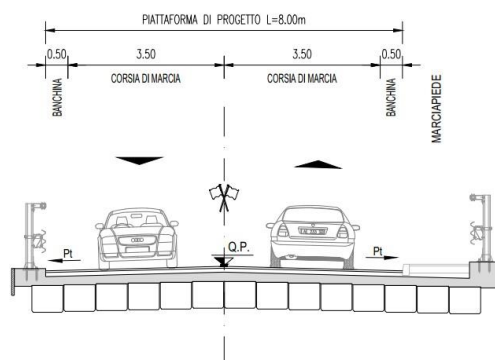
Sezione tipo viabilità interna - ponte Cretesa
